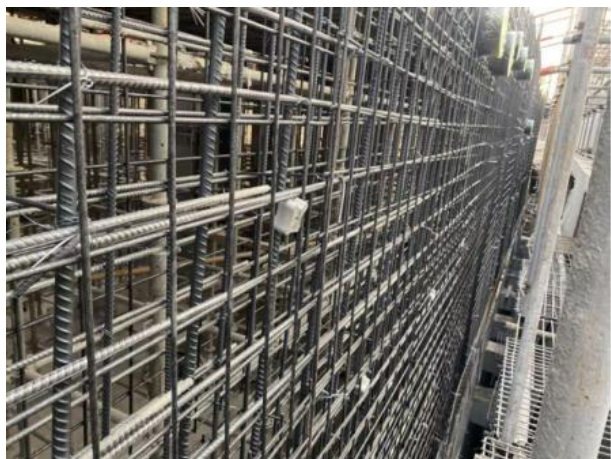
【好】地下室侧墙设置抗裂钢筋网片、地下室外墙设置暗梁
